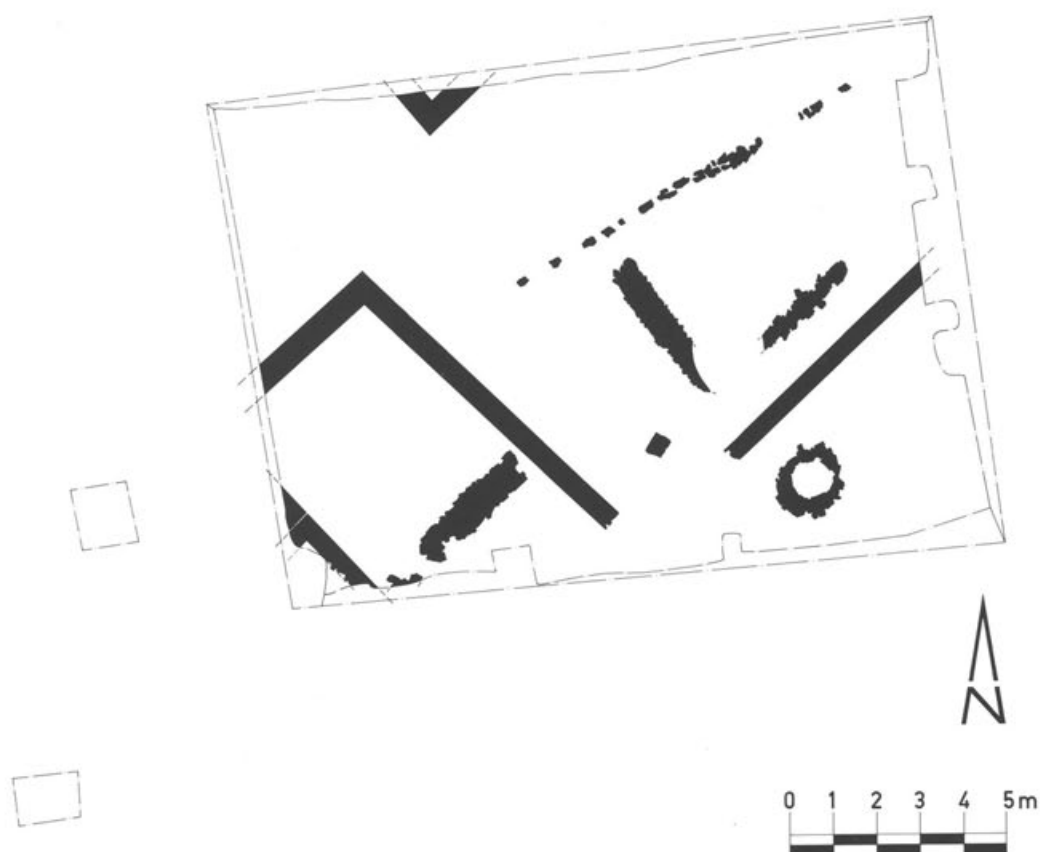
Kaiseraugst, Parz. 157, Abdankungshalle am Friedhof. Grundriss zweier verschiedener Bauten mit einem Sodbrunnen im Südosten. Ansicht vom Kran aus.
